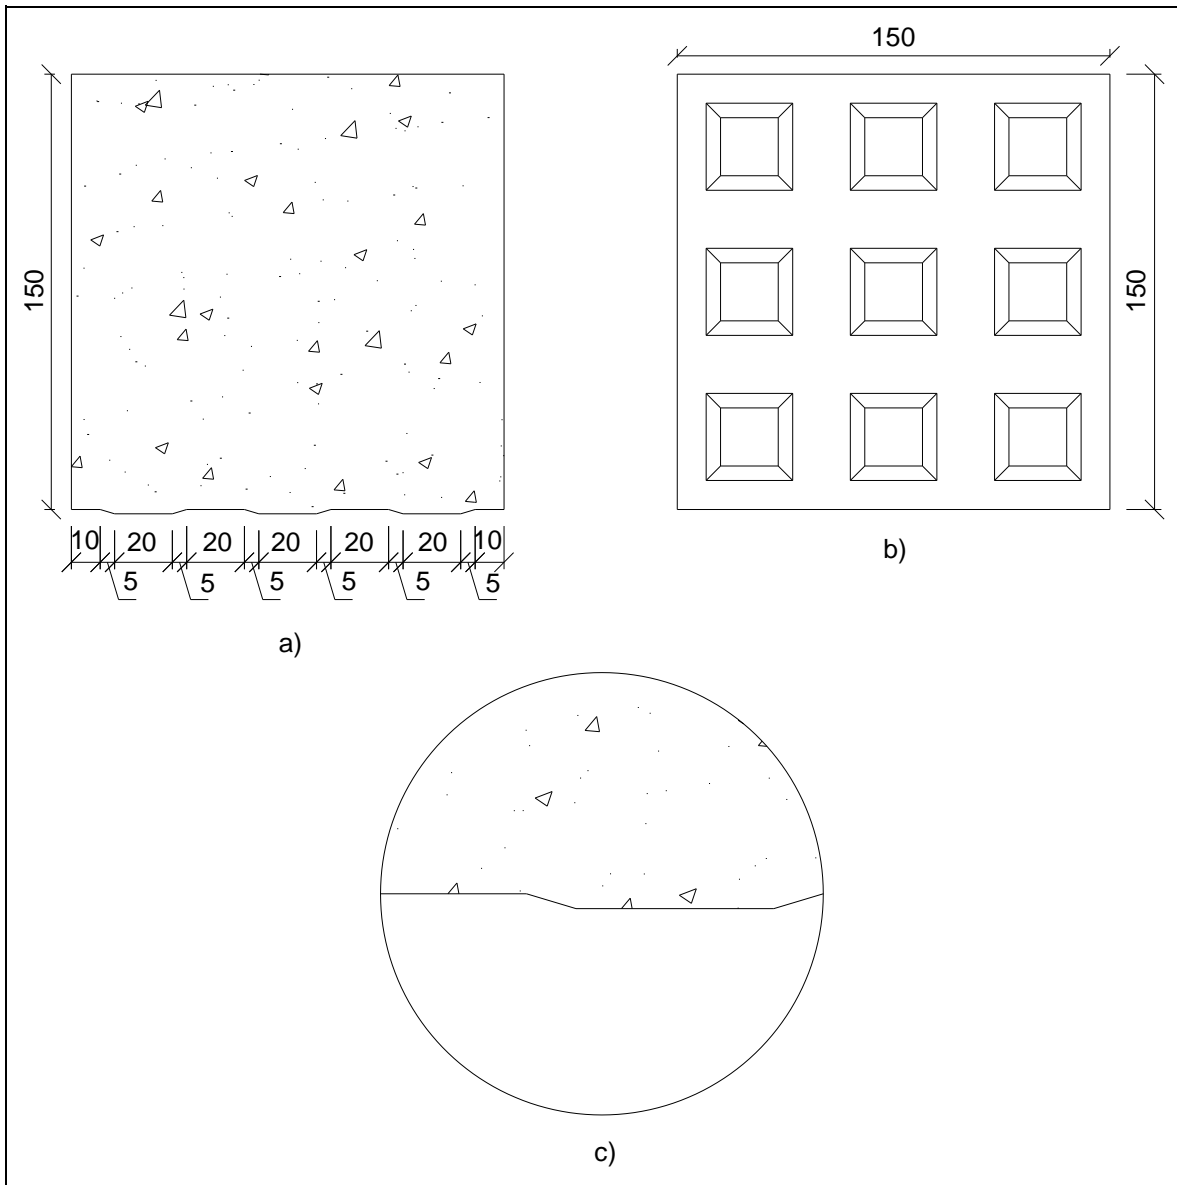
Detalhe do bloco de concreto com nove saliências (dimensões em mm) (Adaptado de El Debs et. at. (2008)): a) Vista lateral; b) Vista da face rugosa; c) Detalhe da saliência do bloco
